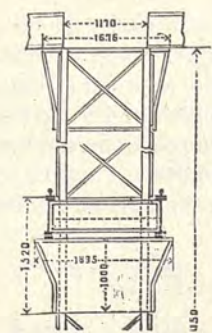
a, b, c. — Pilastro metallico a traliccio.
